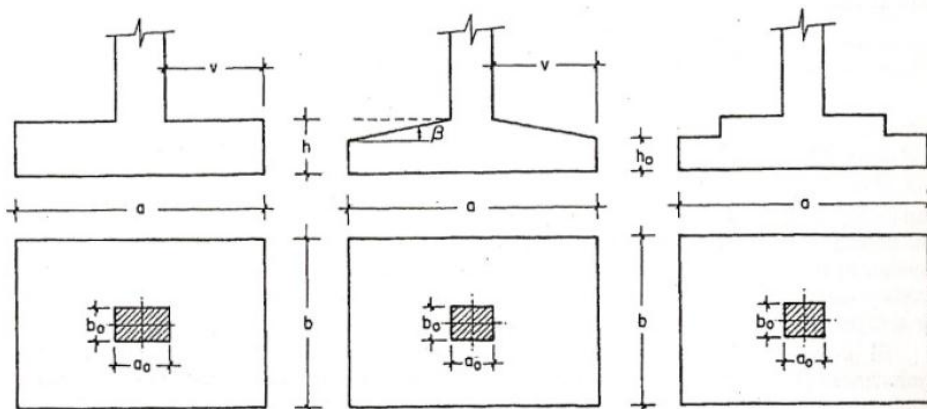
Formas típicas de zapatas, Montoya-Meseguer-Moran
